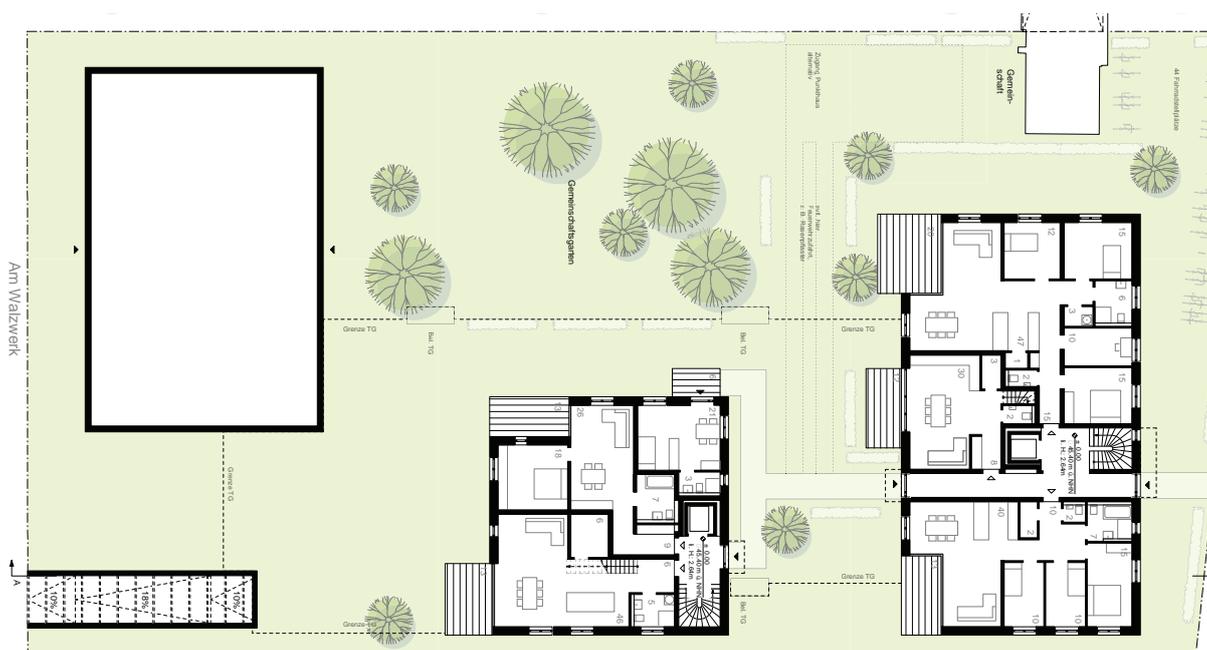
Lageplan zum Projekt, Quelle: Architekturbüro Klaus Zeller GmbH
